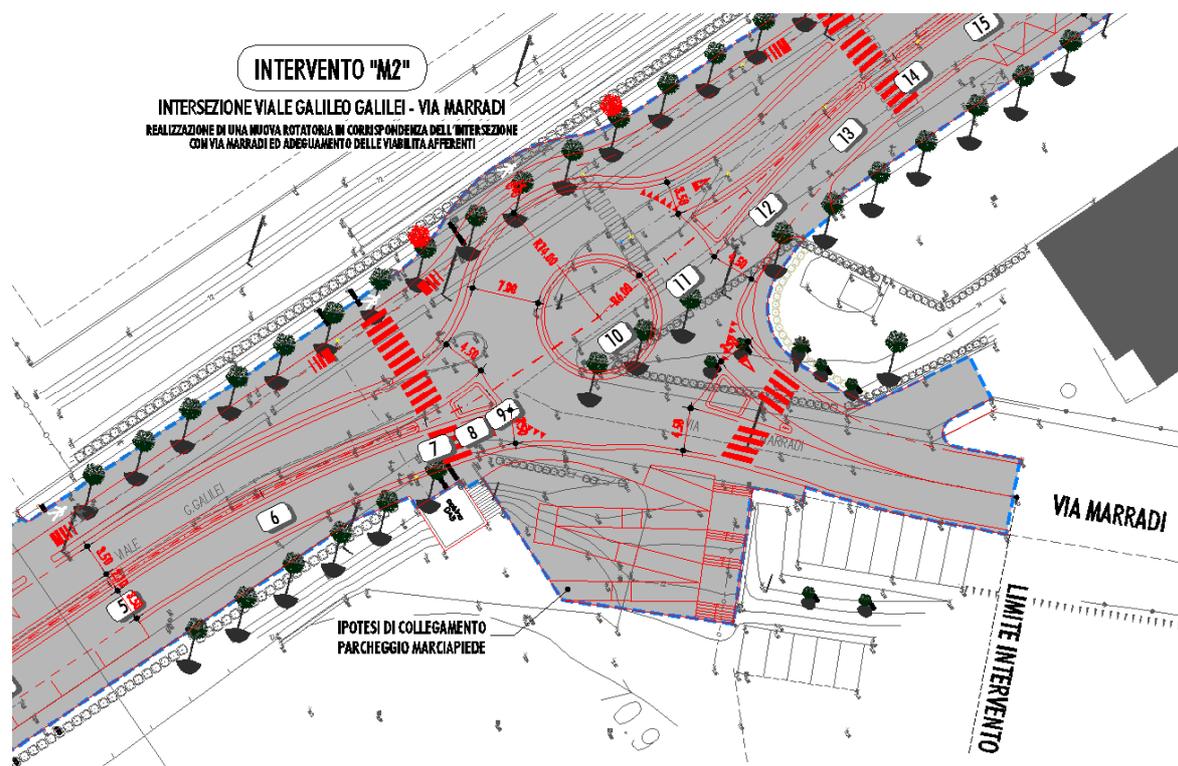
Intervento M2 – Rotatoria via Galilei – via Marradi - stralcio planimetrico di raffronto tra stato di fatto e progetto
